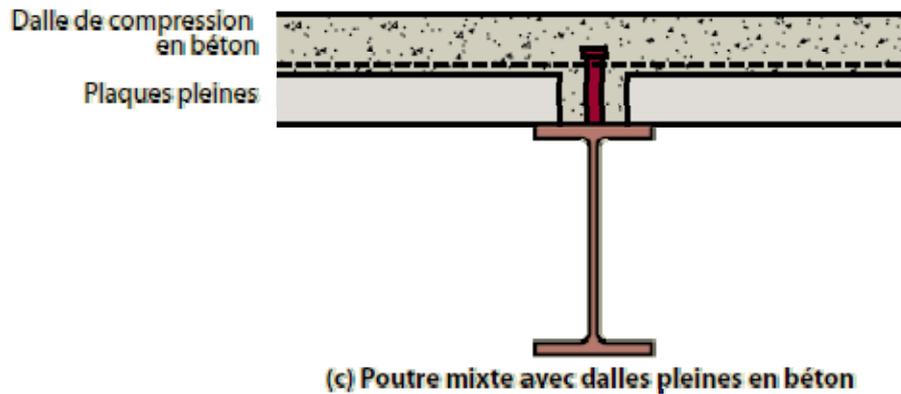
Poutres mixtes utilisées avec des éléments préfabriqués
